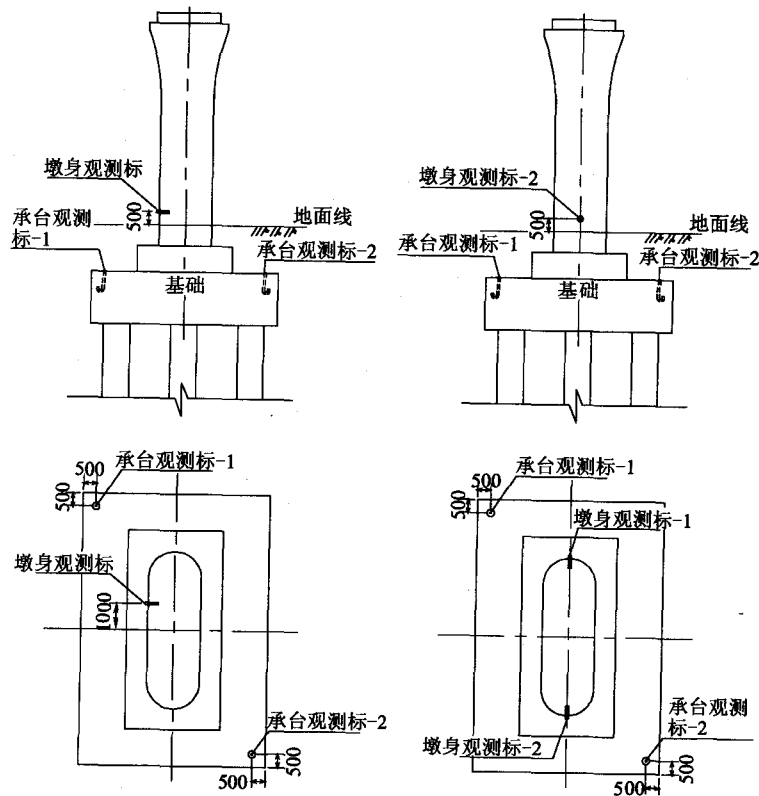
1 墩身及基础沉降观测布置图（单位：mm）
